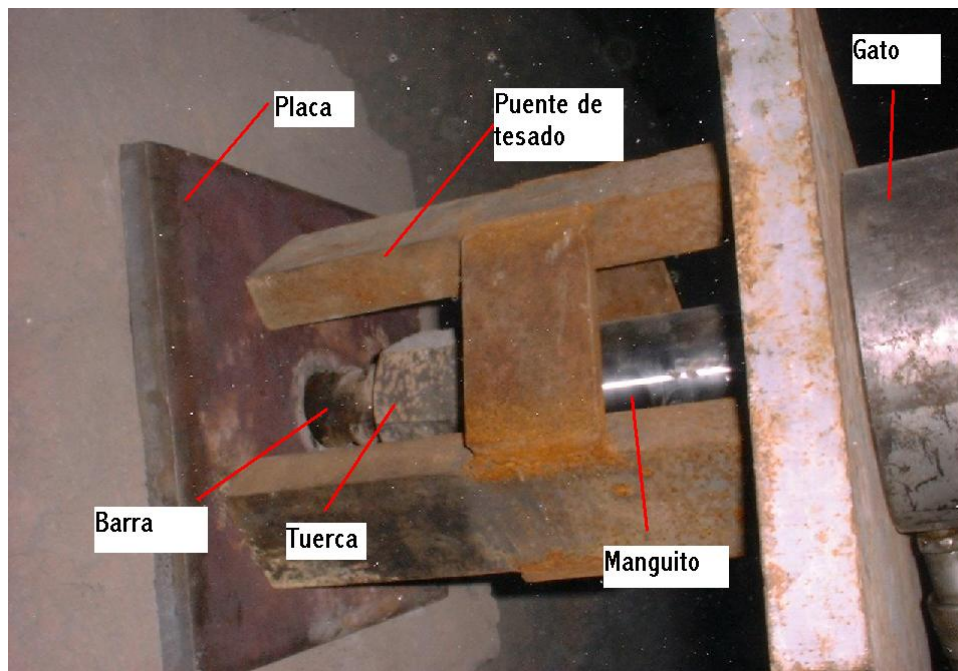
Montaje para tesado de un anclaje de barra (U&A).
